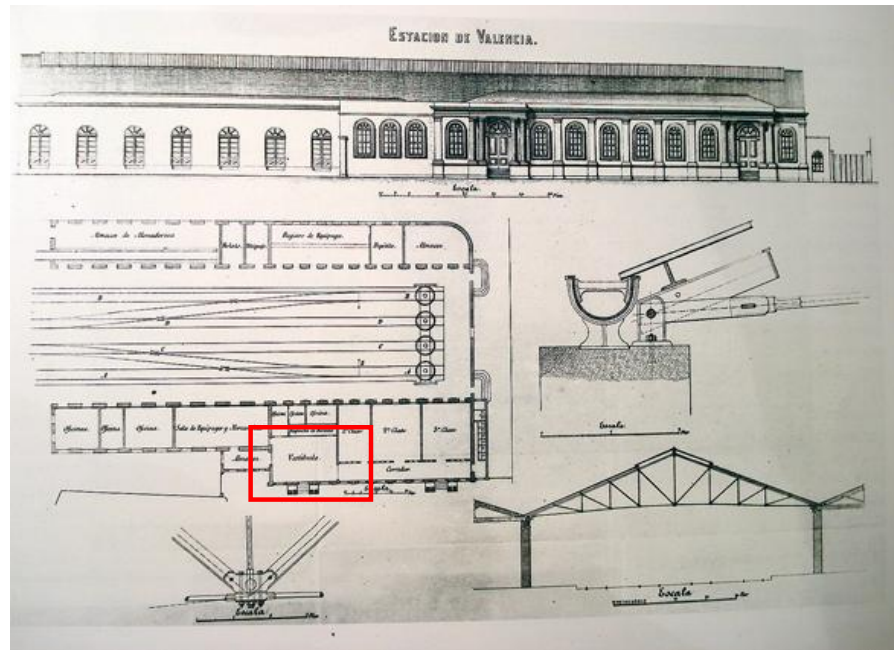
Planta, alzado, sección y detalles antigua E. de Valencia (J. Beatty). (ROP 1857).
